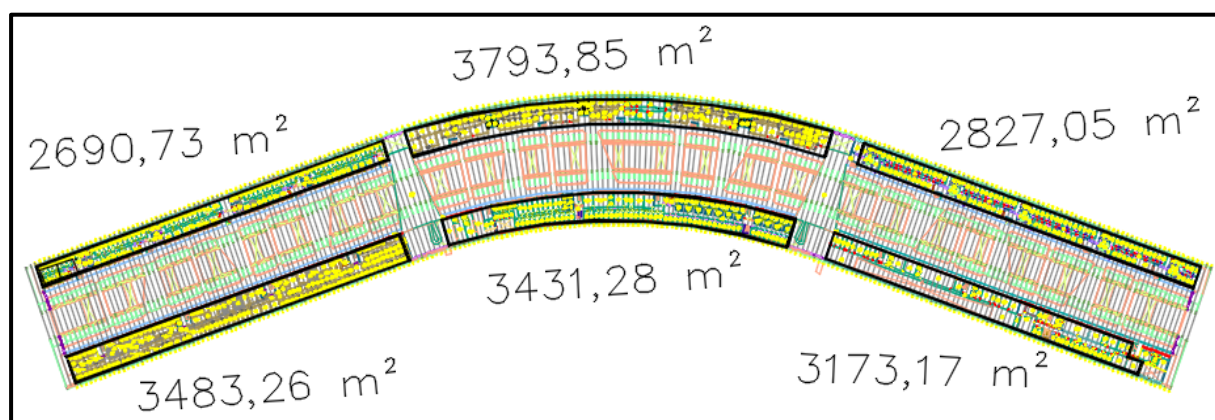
Áreas de cobertura por pavimento da VGA para o ICC
